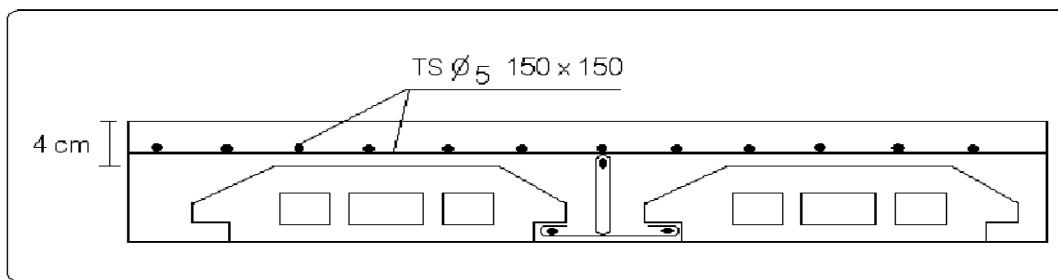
Schéma de ferrailage de la dalle de compression.
